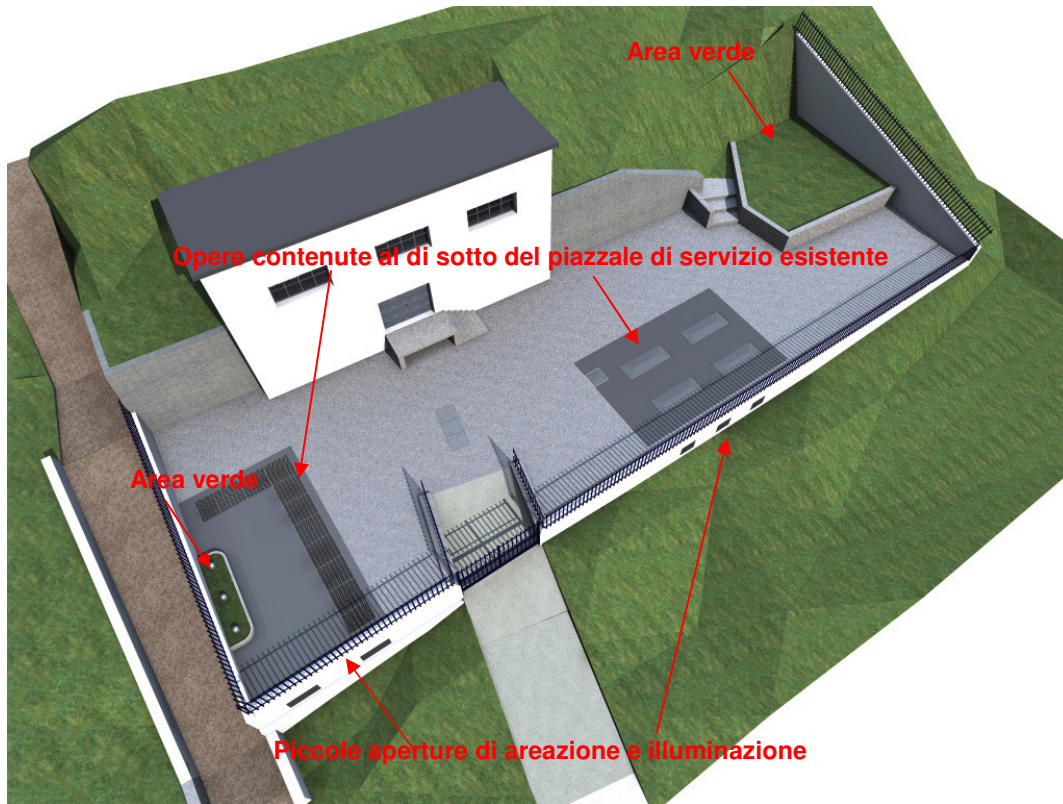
Mitigazione delle opere previste in località San Salvatore
